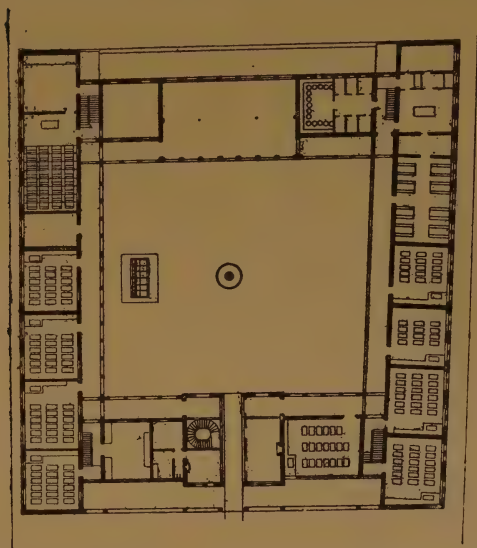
Collège de Tlemcen, plan du rez-de-chaussée
